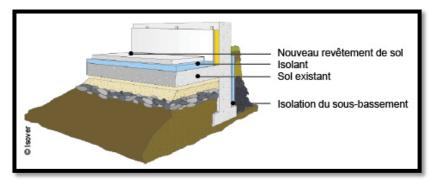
ITE mur extérieur et plancher sur vide sanitaire. Source: Disponible sur: http://www.energissime.fr/particuliers/solutions-techniques/isolation-des-toitures-des-murs-et-des-sols/isolation-plancher-bas-sur-terre-plein-ou-vide-sanitaire-non-accessible/ (consulté 26/12/2016).
